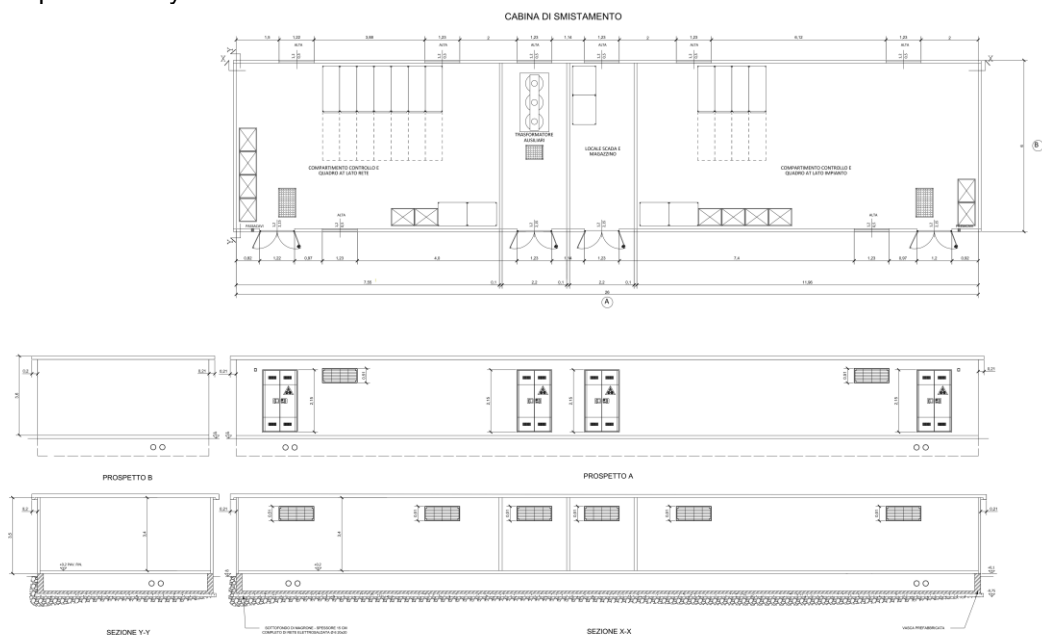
Cabina AT di smistamento - Vista in pianta e prospetto
